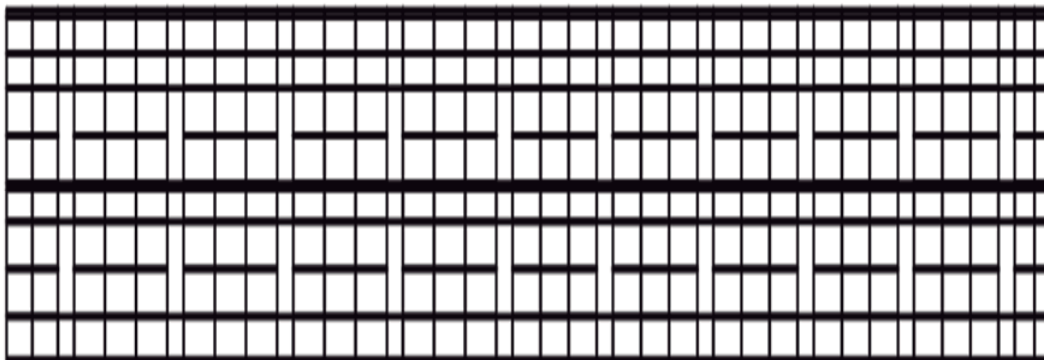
Modelo de elementos rígidos para la fachada poniente.
